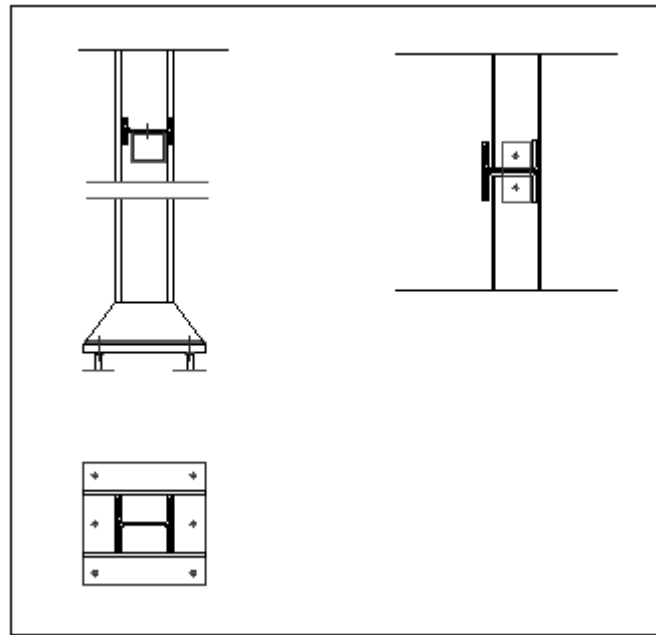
Unió d'una corretja IPE en un pilar HEB.
